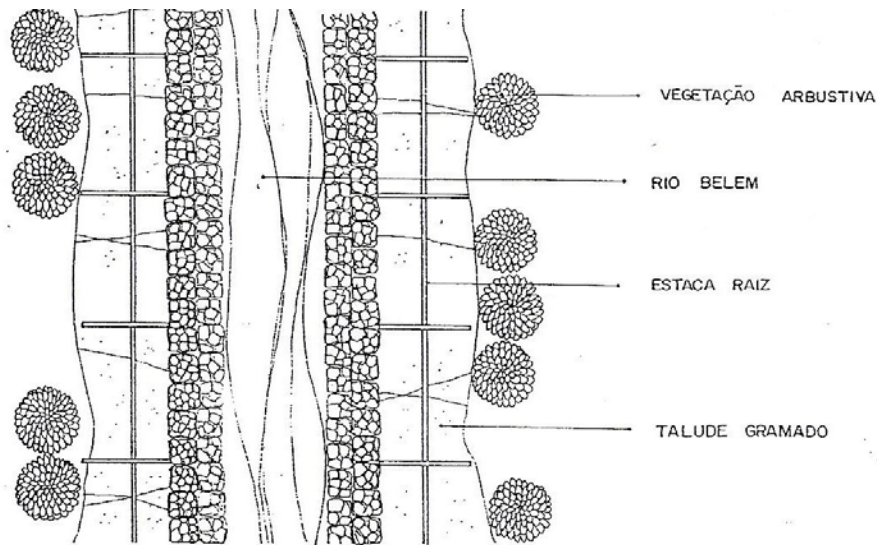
Planta do revestimento de fundo e do tratamento de talude.
